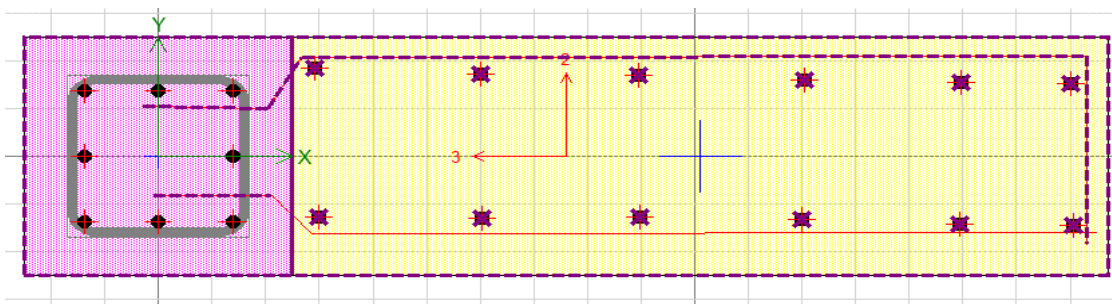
Incremento de la sección transversal de la columna existente. Fuente: Elaboración propia.
